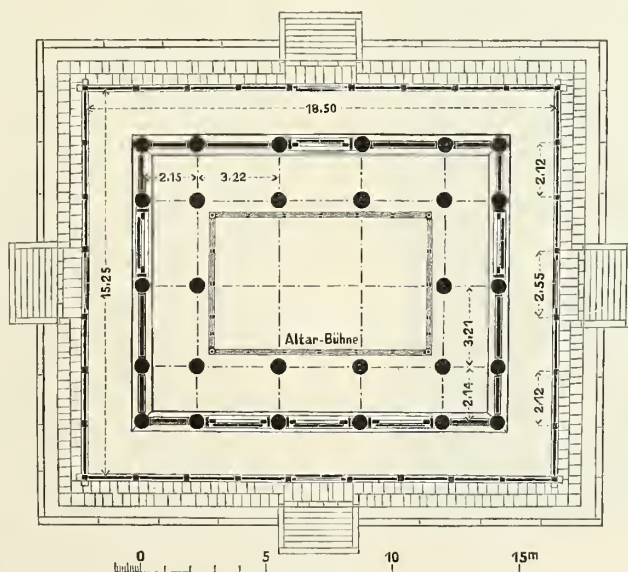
Haupttempel, Kon-do (Goldene Halle). Grundriss.
